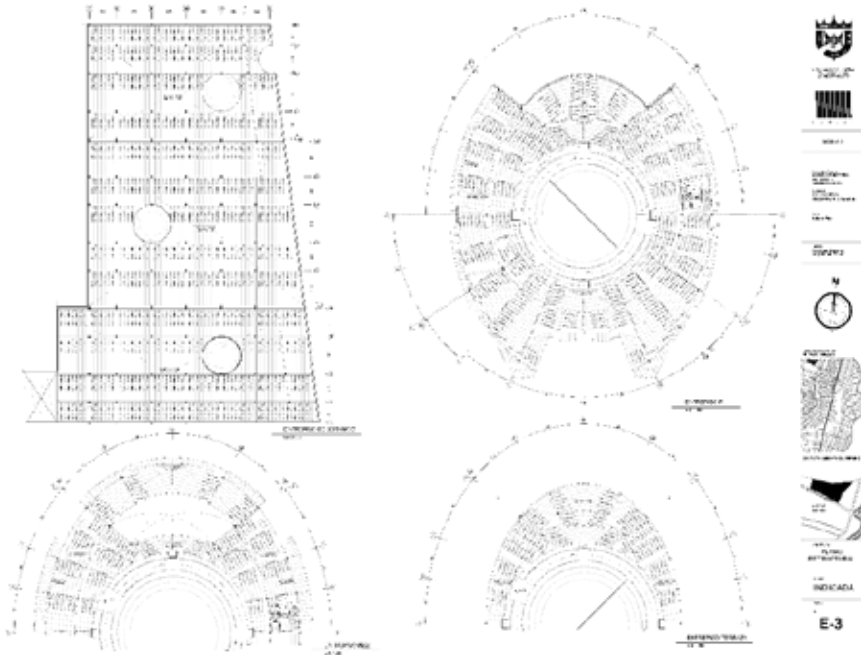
Estructura Losas de entrepisos. Fuente: Autor (2021).
